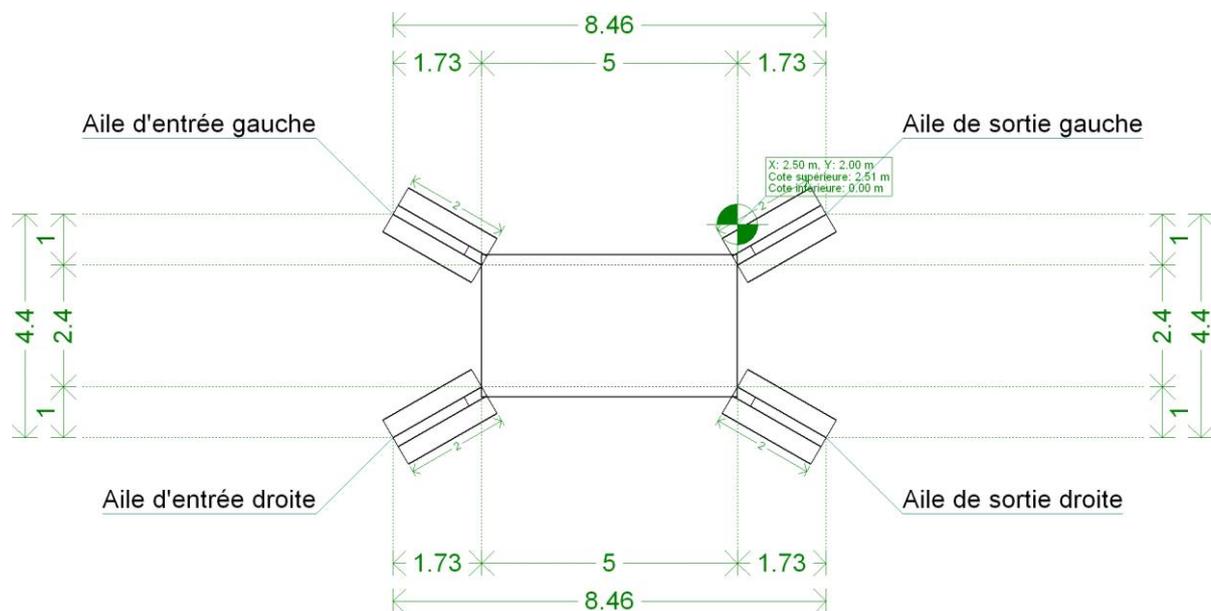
Géométrie du dalot de franchissement sur canaux ou drains primaires
